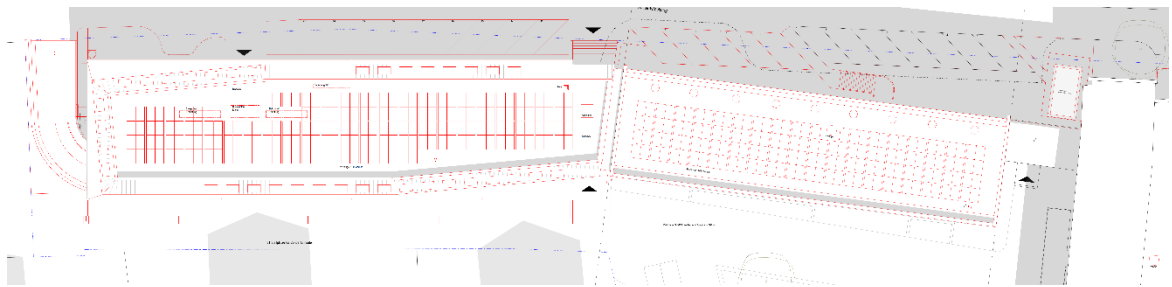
Lageplanausschnitt (ohne Maßstab) Stand 05.06.2025
